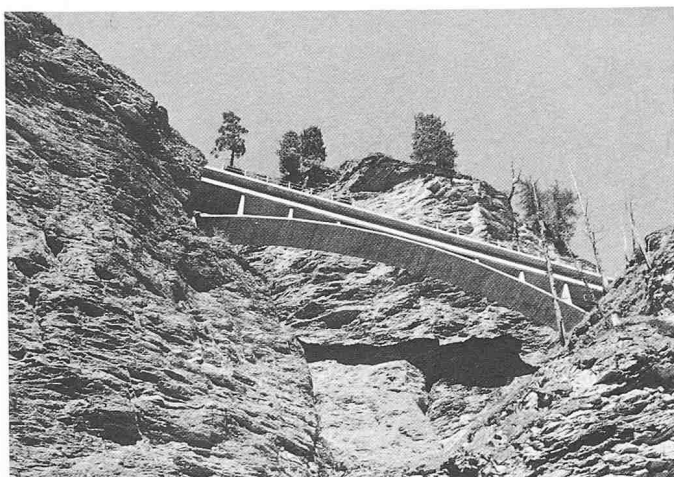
Brücke «Unter Platta Nr. 3» im Avers
